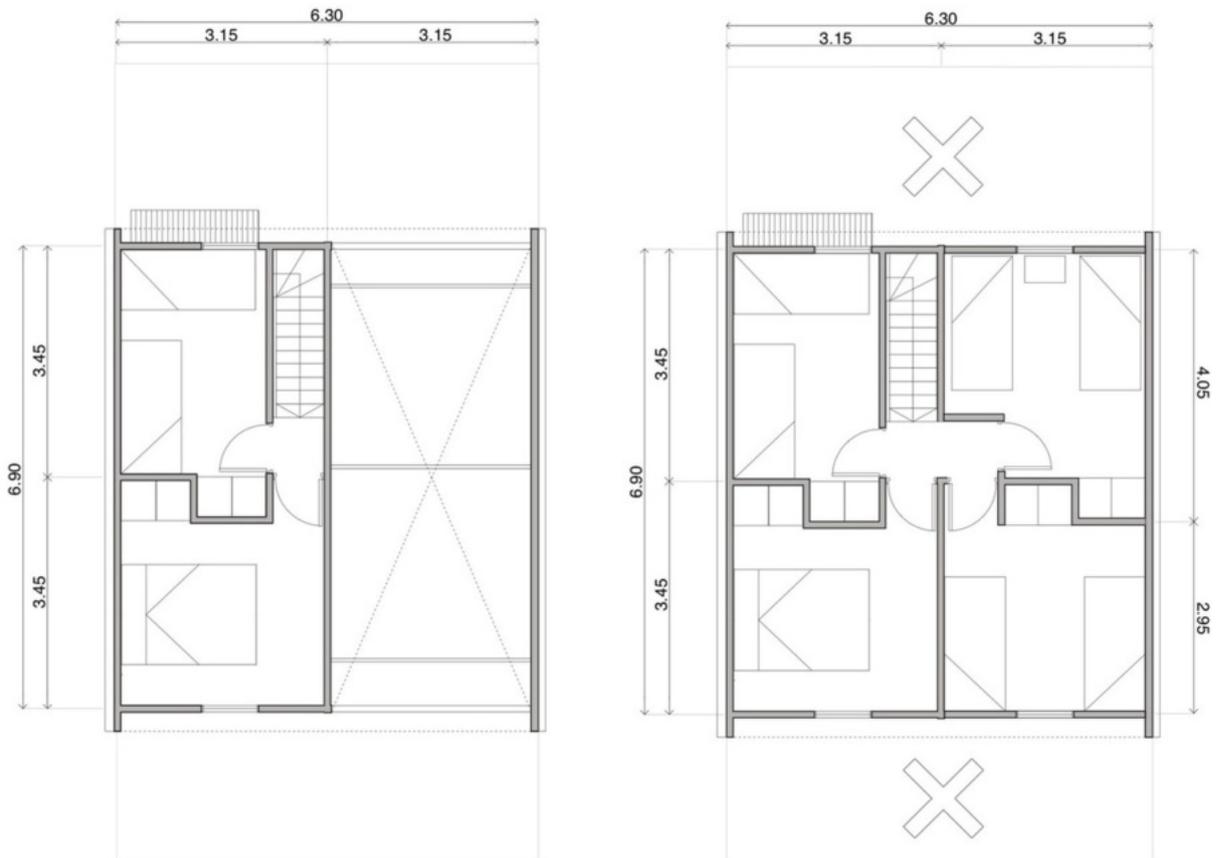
Planta baixa superior com proposta de ampliação. Fonte: ArchDaily, 2010.
